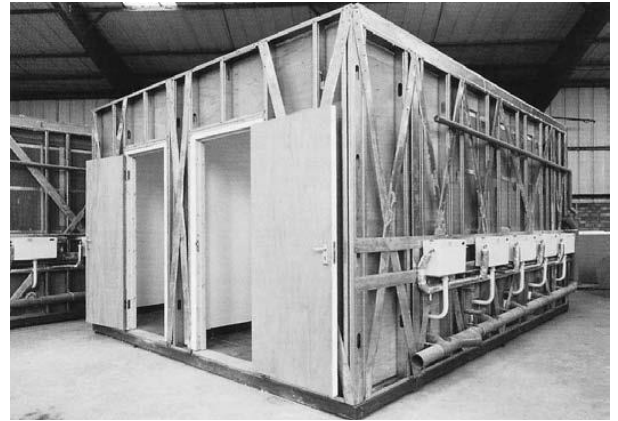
, Paneles son prefabricados en plantas de prefabricación y llevados a la obra para el montaje de la estructura. (Fuente: <http://www.aegismetalframing.com>).
